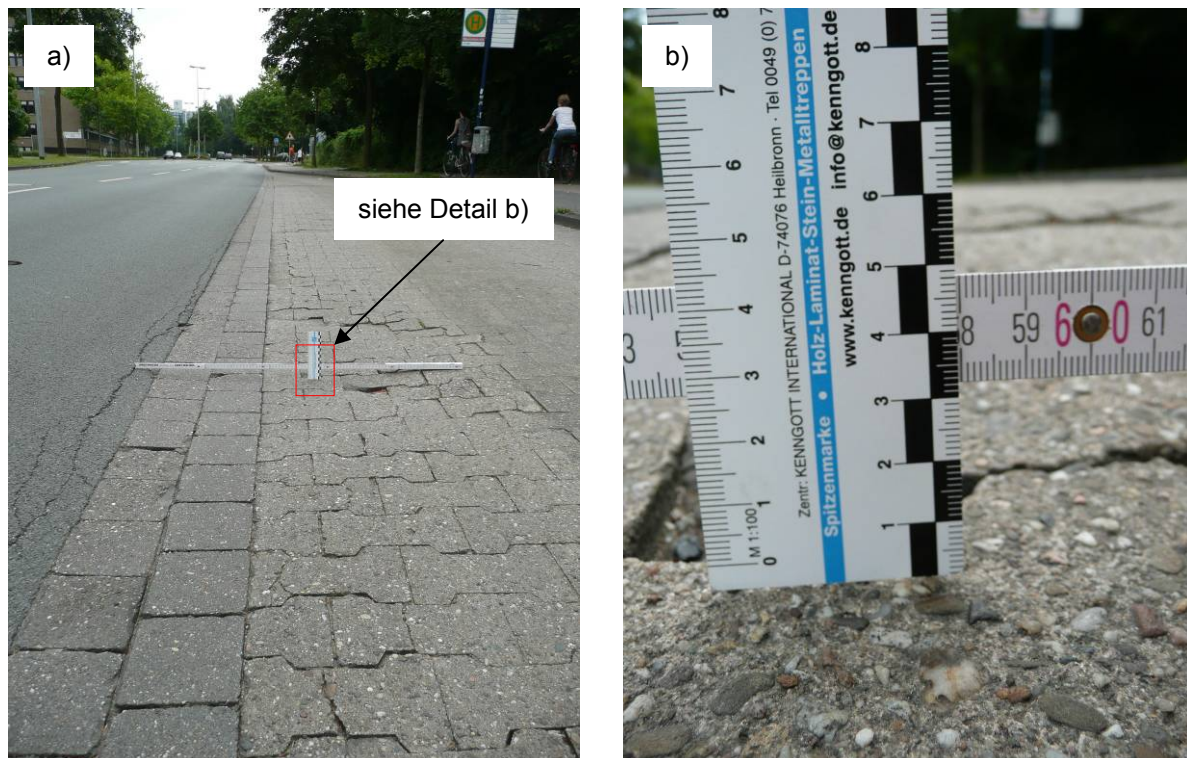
gepflasterte Busspur: Spurrillen, gerissene Steine, Risse im angrenzenden Asphalt oberbau, b) Detail: Spurrillentiefe mit ca. 32 mm Tiefe
